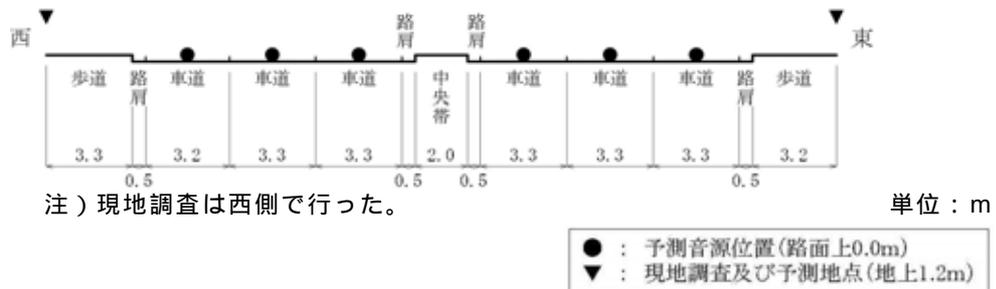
(2) 音源配置図(道路断面方向の配置イメージ: No.3の例)
